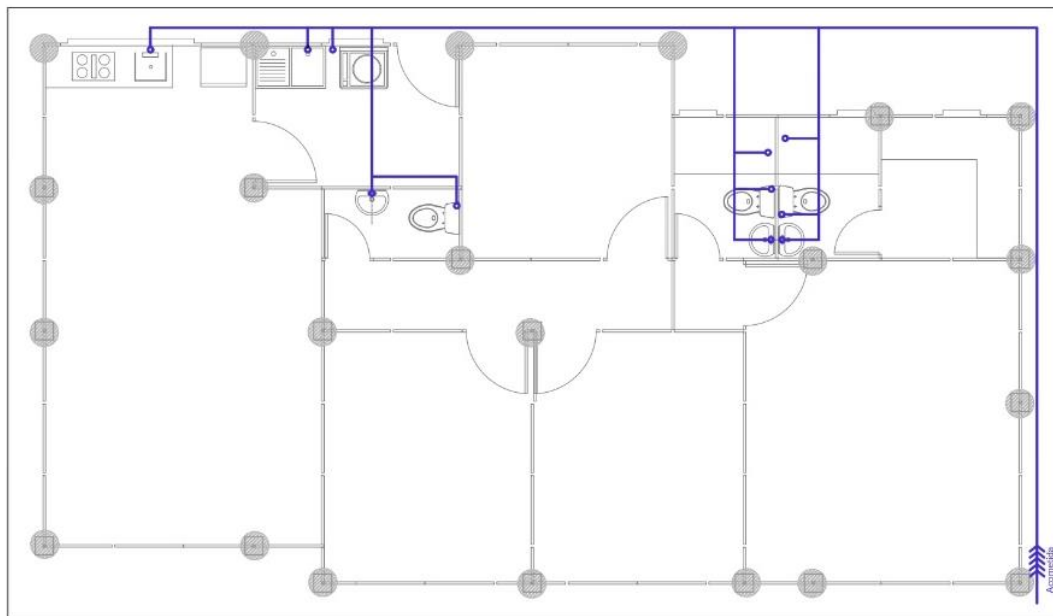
Aplicación de la plantilla modular en plaquetas
